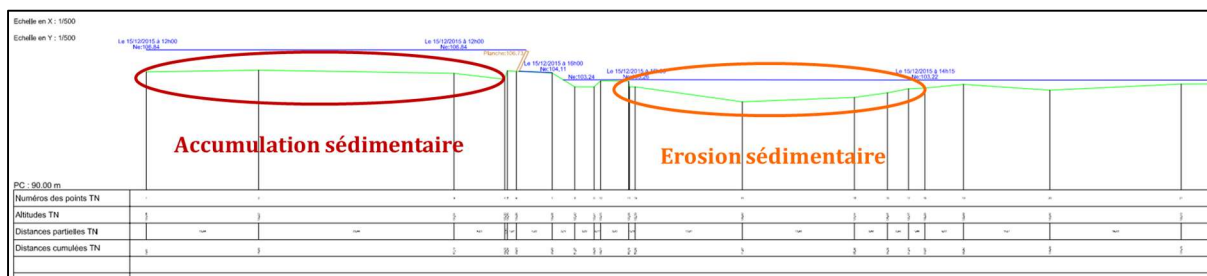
Profil en long n°1 issu des plans (annexe 2).
